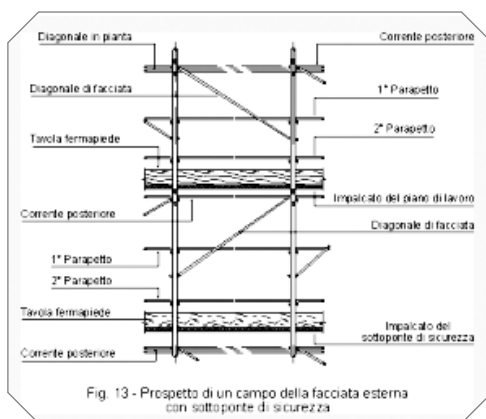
Prospetto di un campo della facciata esterna con sottoponte di sicurezza
